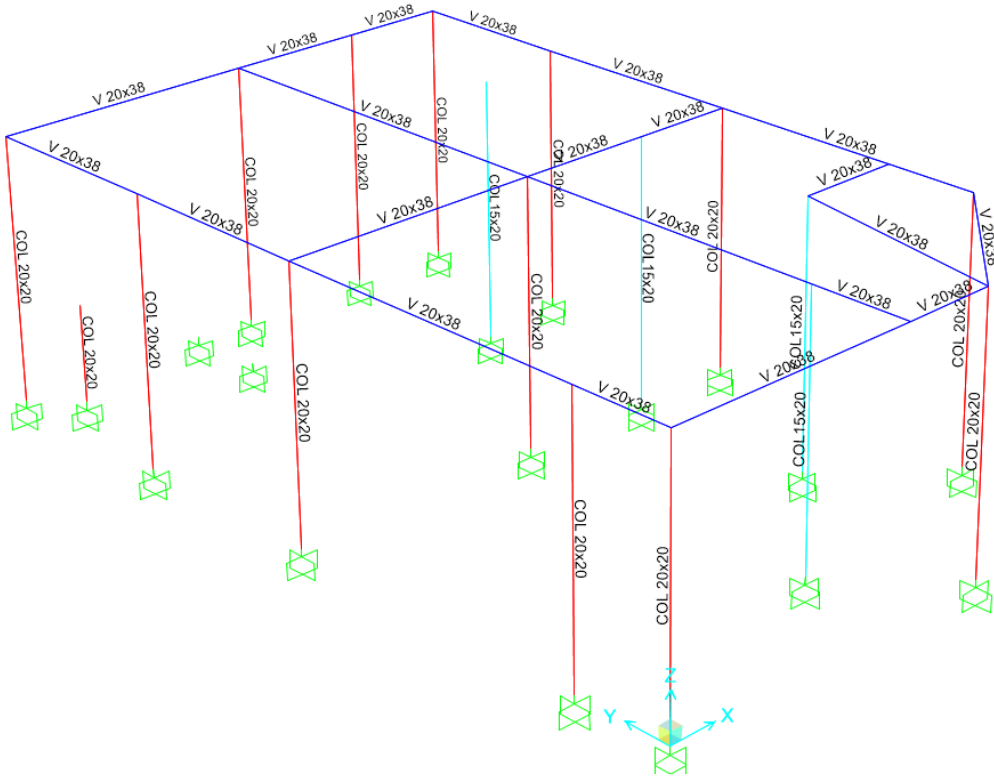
Se puede visualizar que la sección de columnas en planta baja es menor que la sección de columnas en el primer piso alto.
